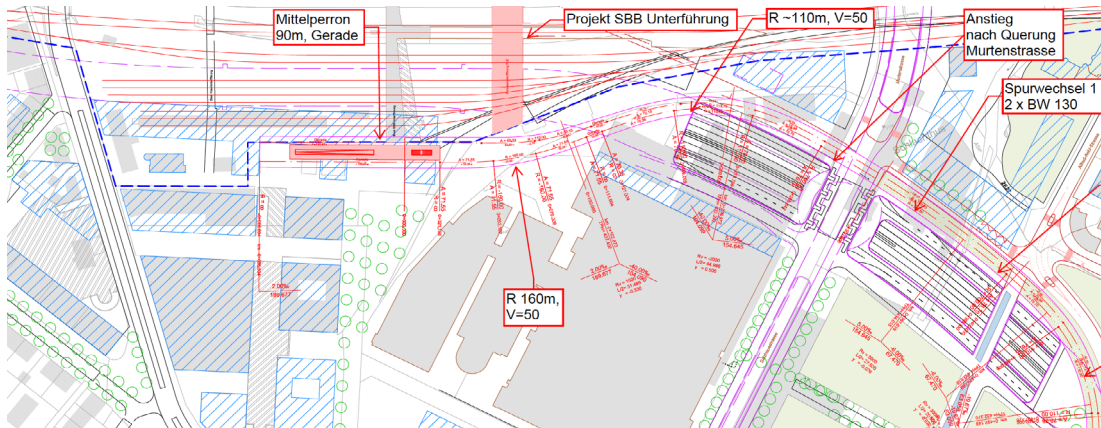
Variante Hochlage, parallel SBB ohne Abstellanlage/à Niveau Salzhausstrasse (Quelle: ASm & Stadt Biel, 2018).
